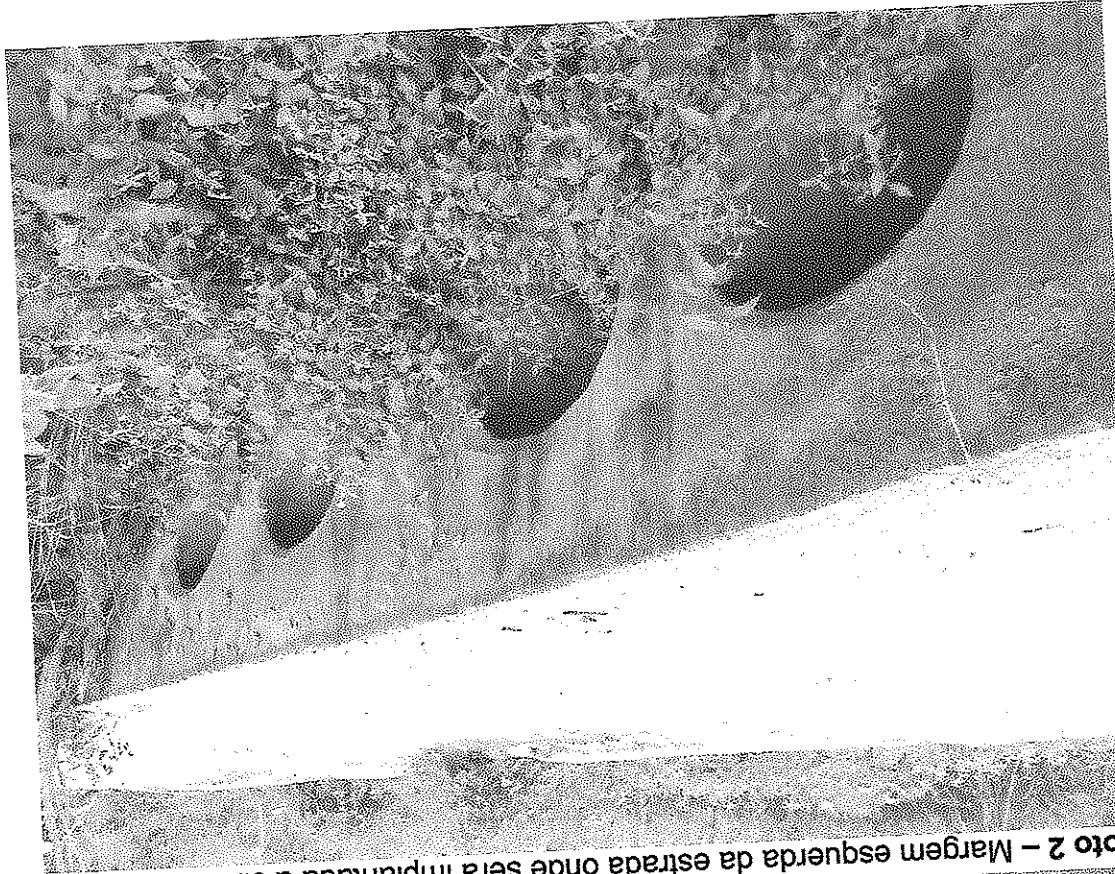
Margem esquerda da estrada onde será implantada a obra.
